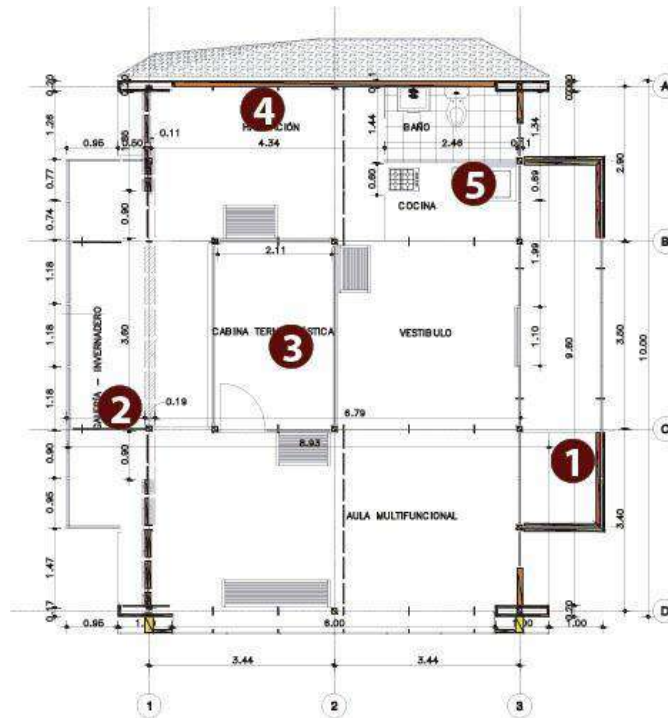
Planta arquitectónica con ubicación de sensores HOBO. Elaboración propia
